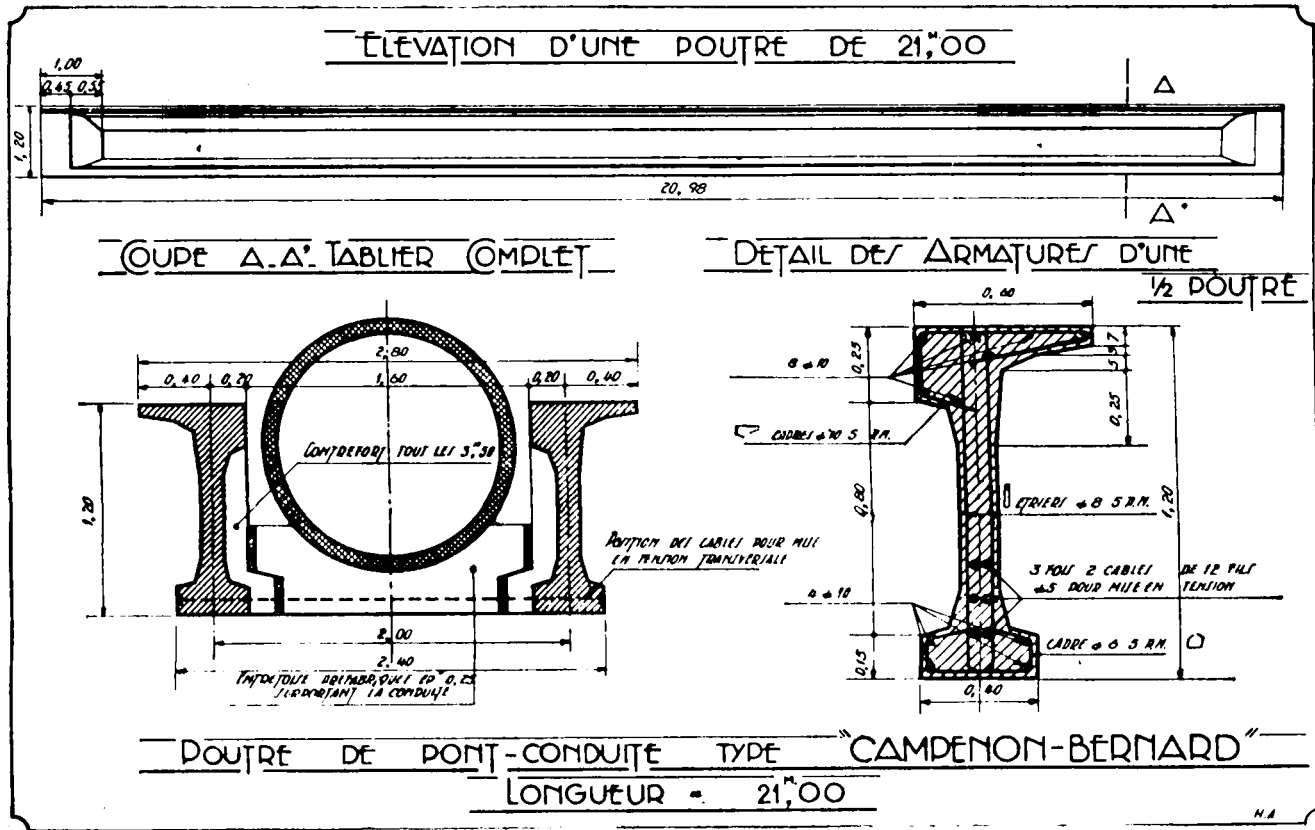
Poutre de 21 mètres (Compenon-Bernard)
